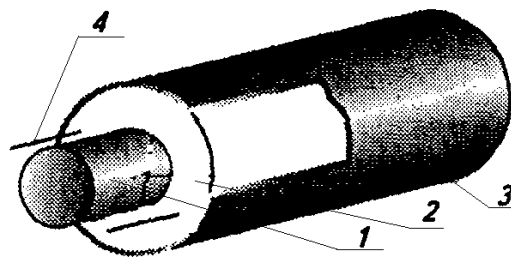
Трубопровод тепловой сети с конструкцией из пенополиуретановой теплоизоляции (используется для подземной прокладки).
